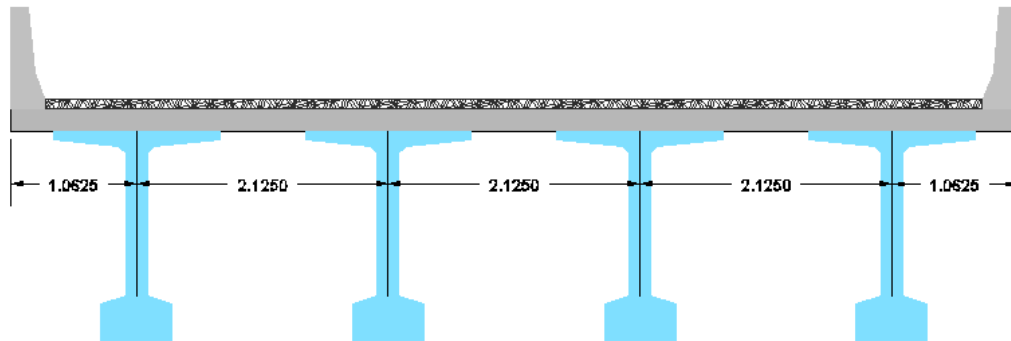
SECCION TRANSVERSAL DE LA SUPERESTRUCTURA PUENTE
